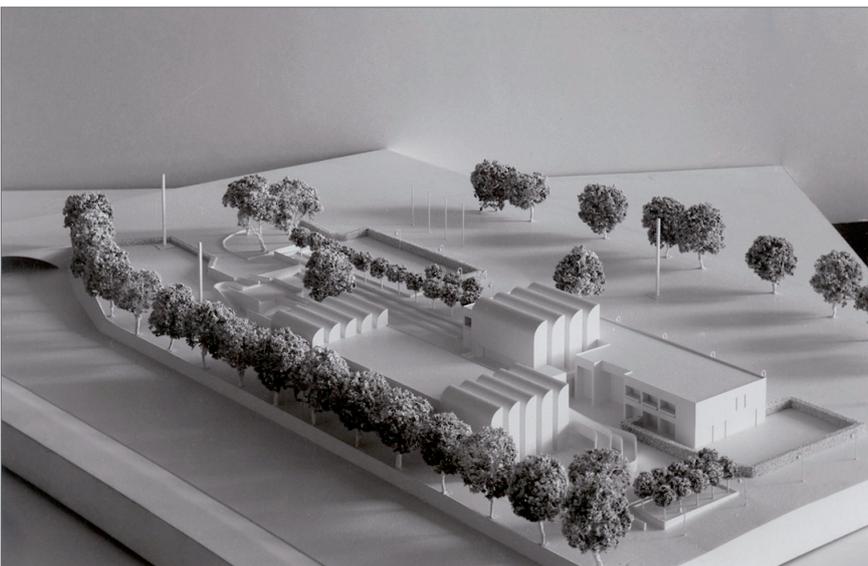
Architekturmodell, Planungsstand 1976 - 78 für den Standort Berlin. Die Ausstellungshalle im Vordergrund ist nach Süden geöffnet.
